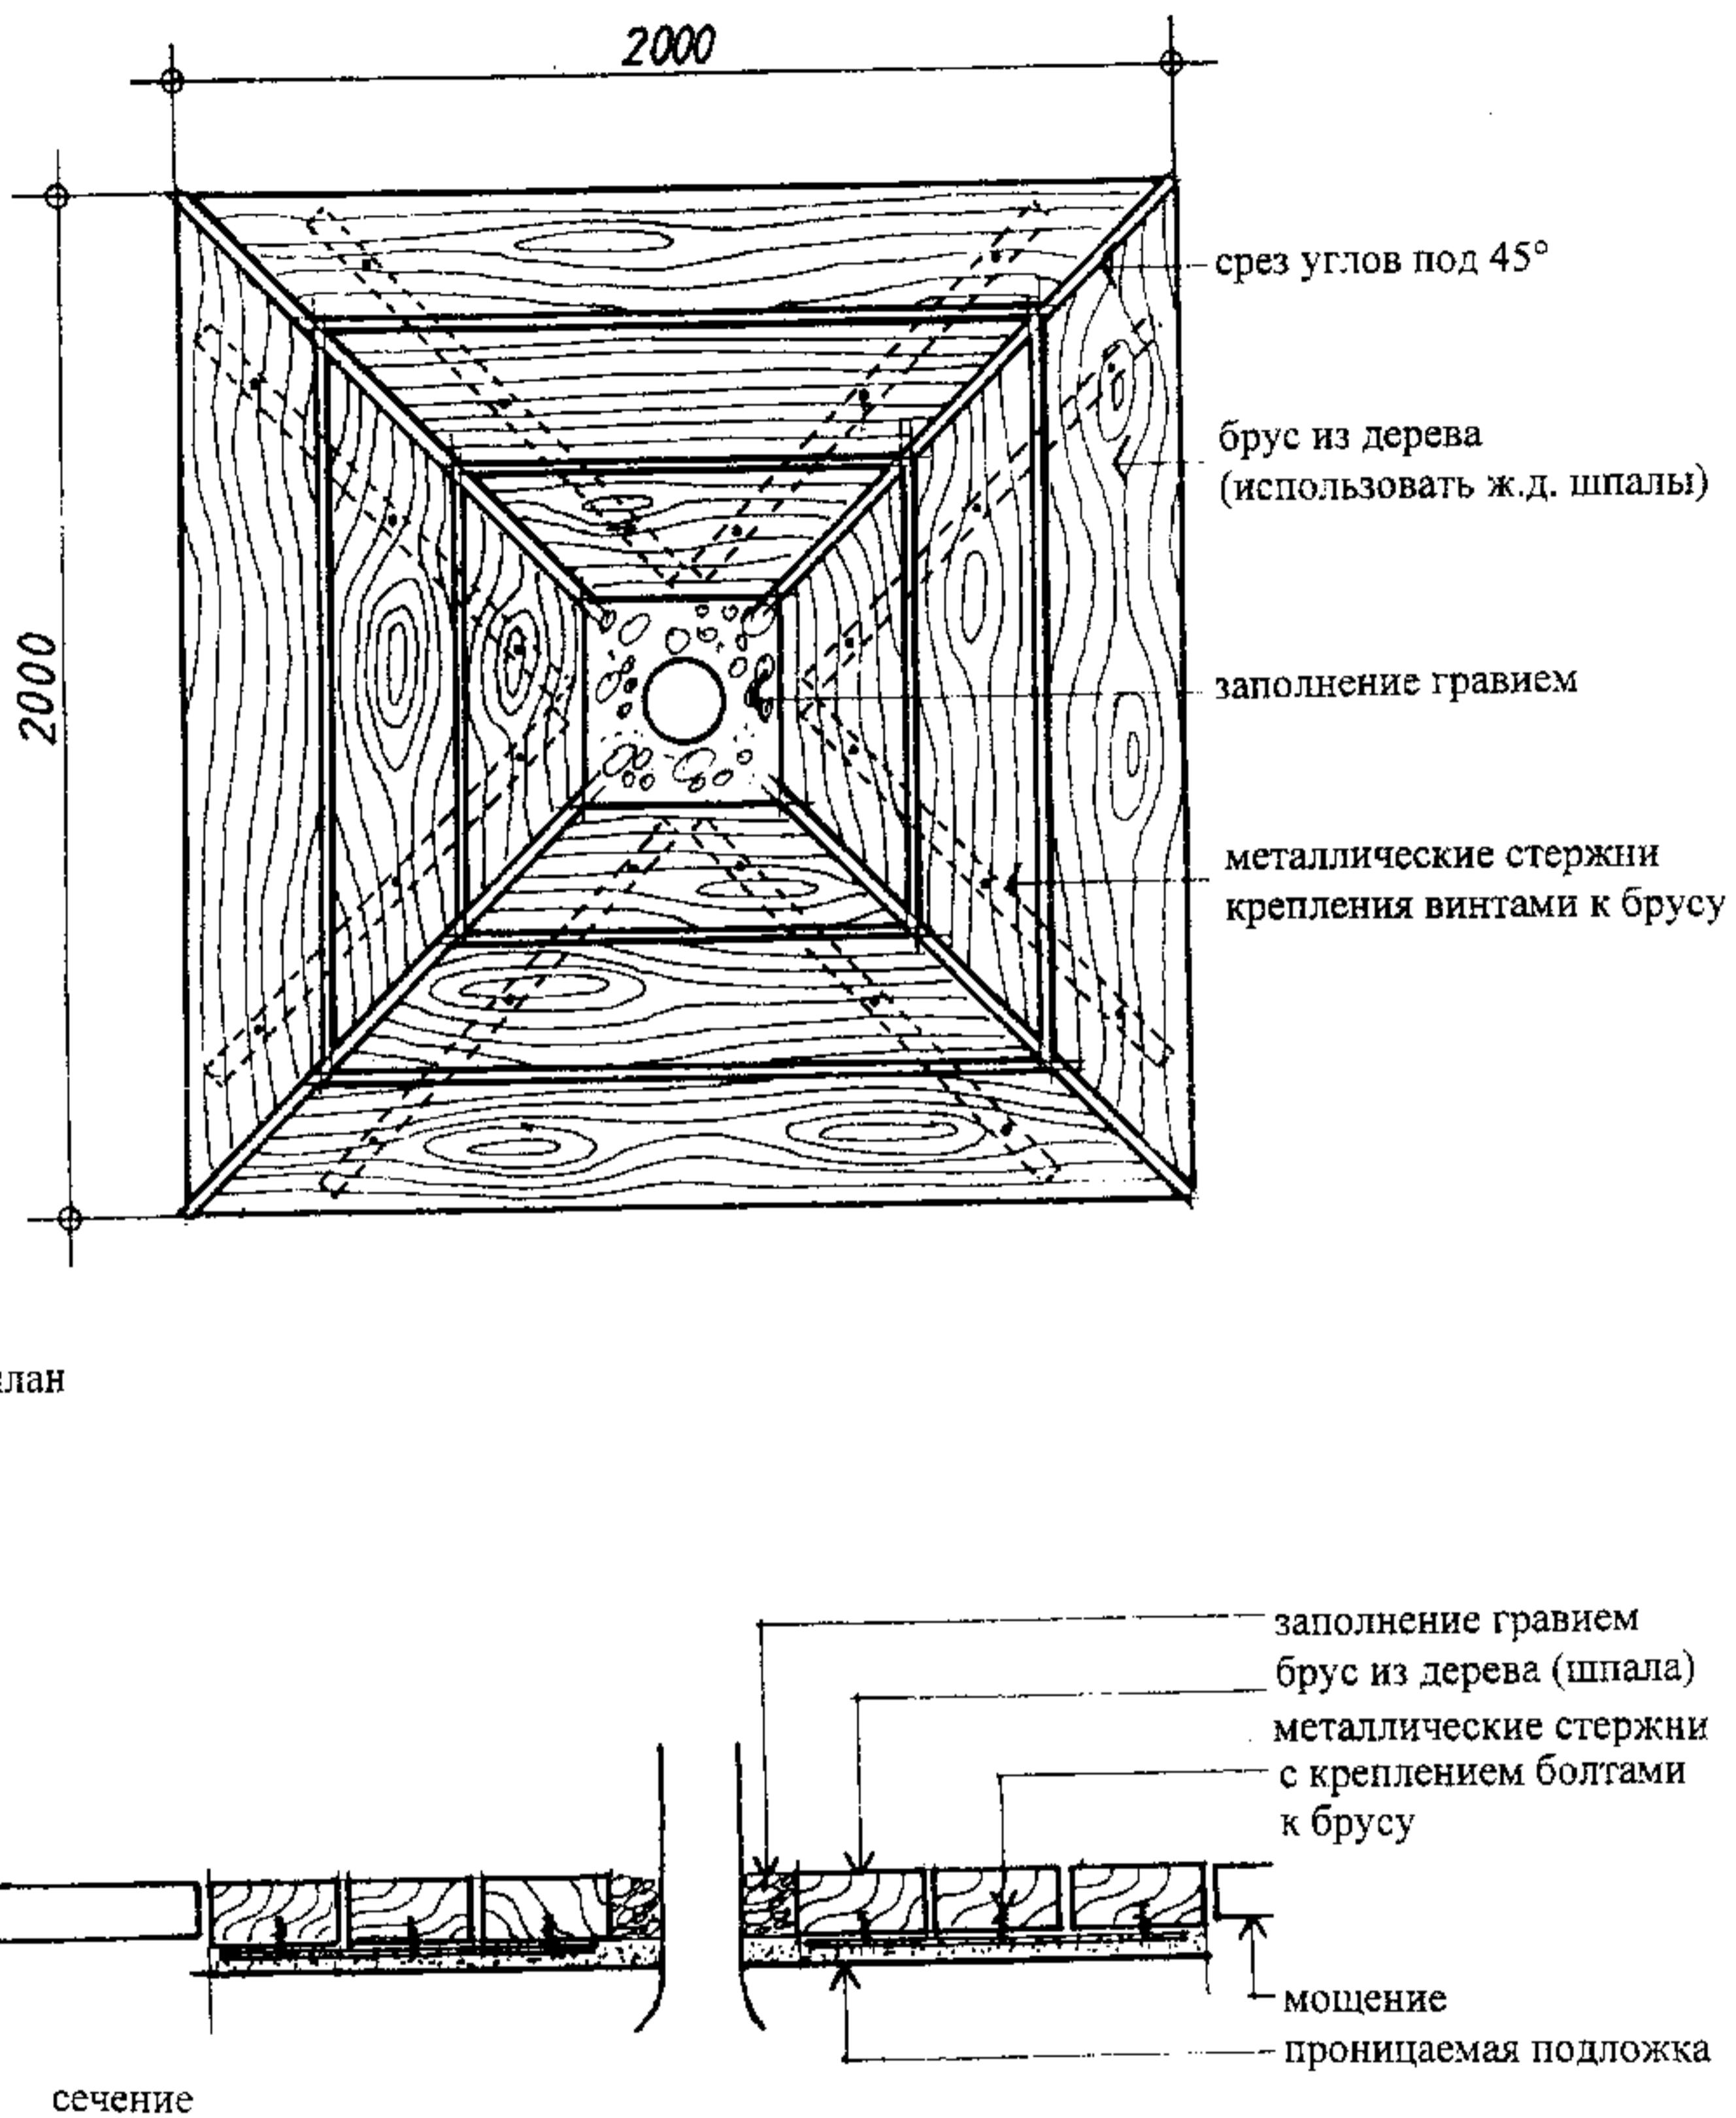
Посадочное место дерева, покрытое деревянными брусками
